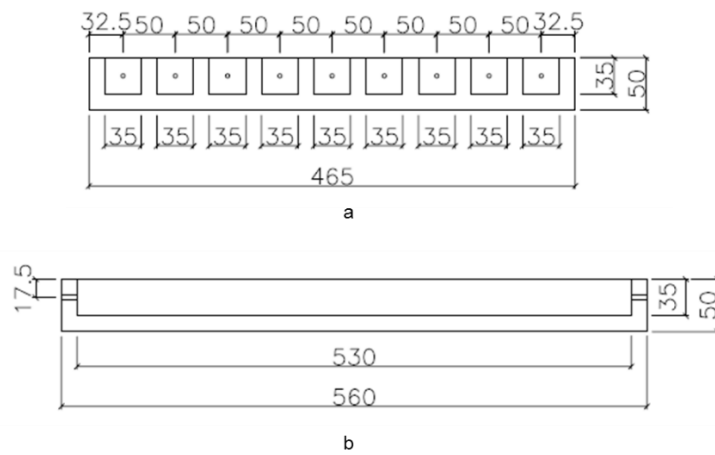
Detalhes da fôrma para tirantes para o aço CA-60, com dimensões em mm: (a) corte A-A'; (b) corte B-B'.
